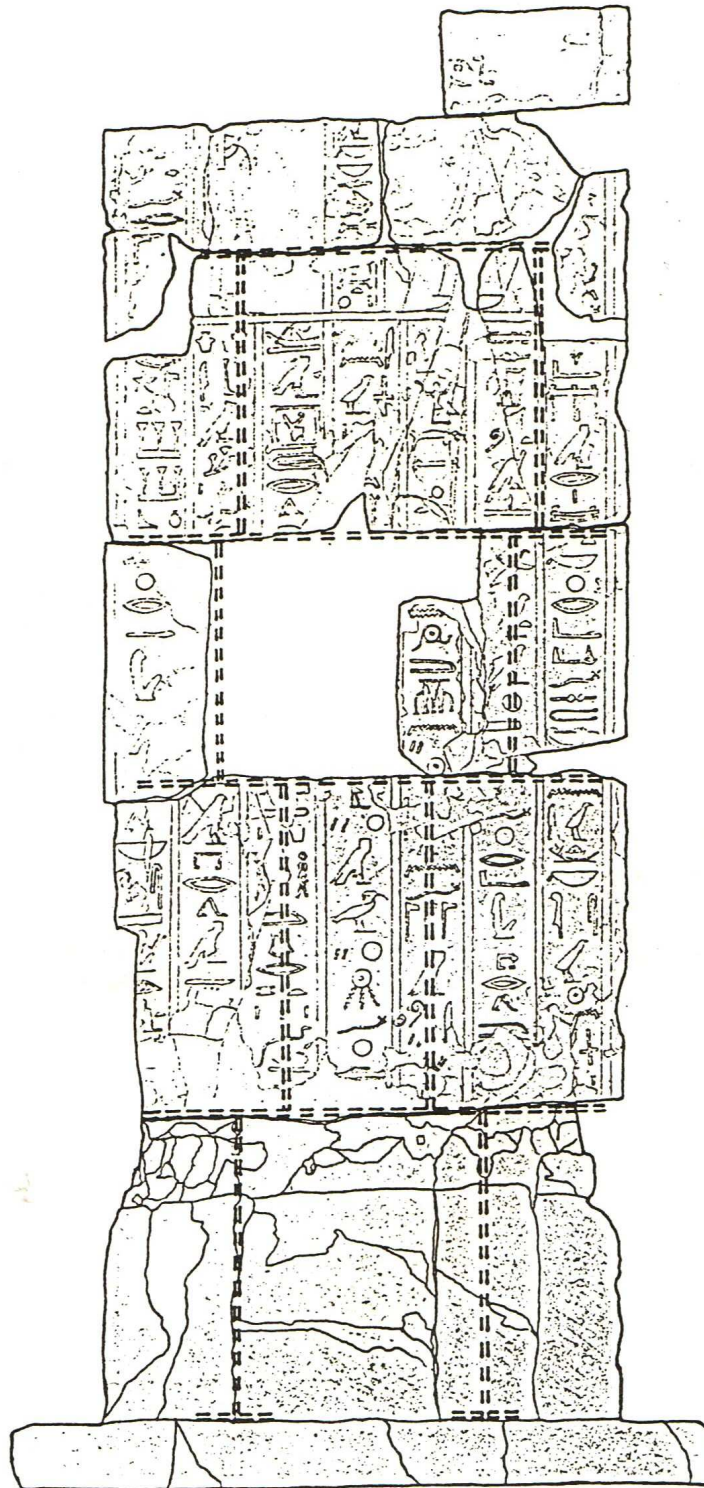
Sala a pilastri. Pilastro sud-est, facciata est. Struttura metallica interna tratteggiata.
